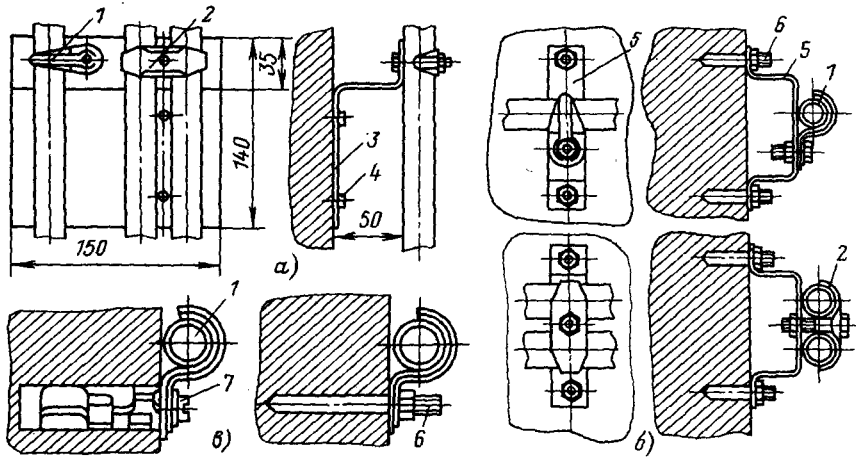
Крепление одиночных трубных проводов диаметром от 22 до 60 мм на бетонных и кирпичных основаниях:
